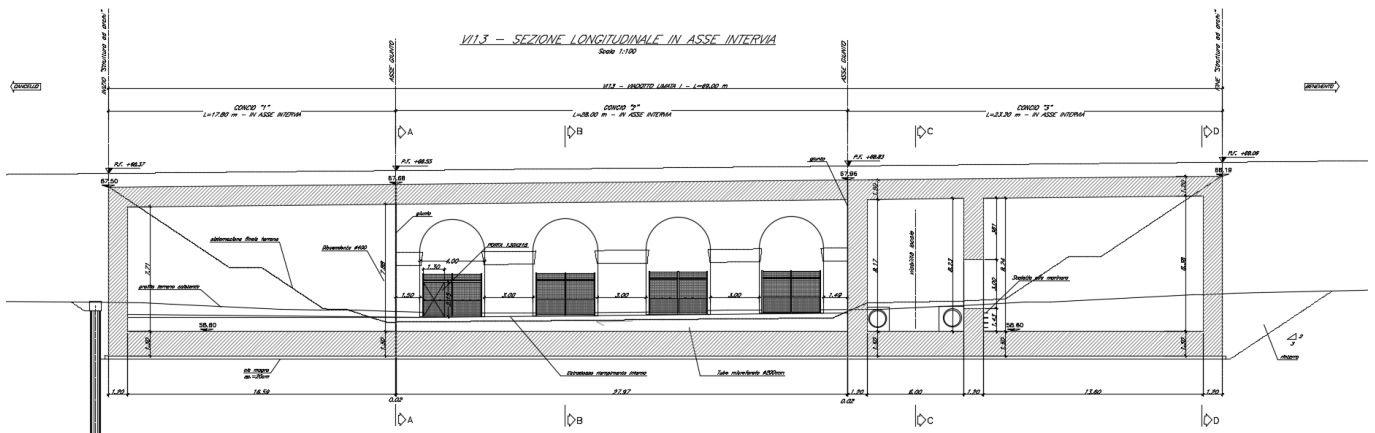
Sezione longitudinale del VI13 - “struttura ad archi”
